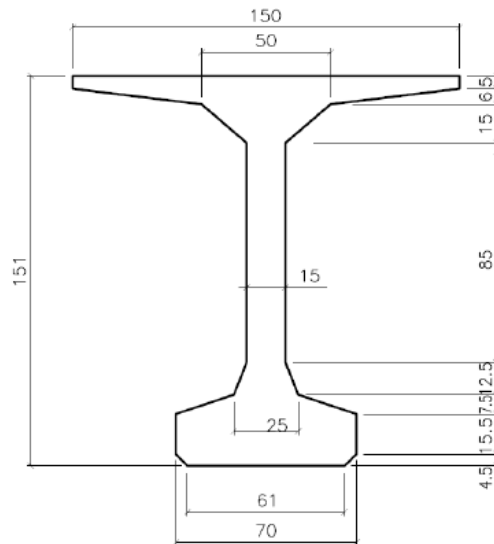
Sección transversal viga pretensada puente Chada [17].
